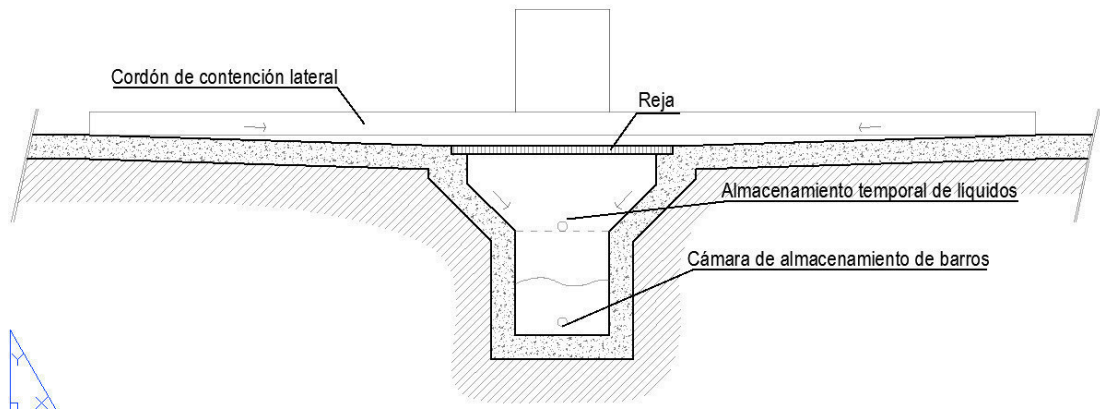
| Rampa con reja para lavado. Corte A-B.-
